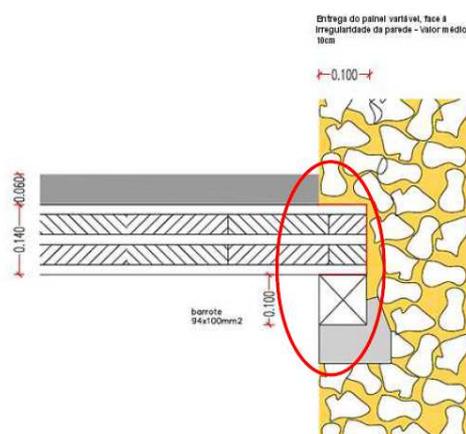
Pormenor construtivo de apoio de laje CLT. (cedido pela Tisem)
